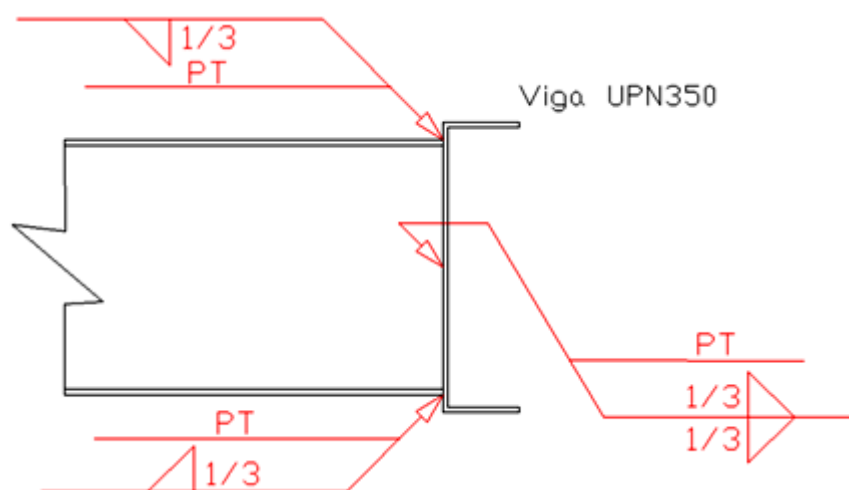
UNION DE VIGA UPN300 A LA VIGA UPN350
